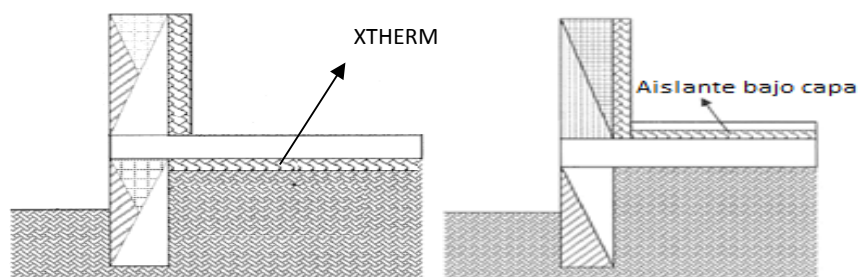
solución “Fibra Xtherm” y solución aislante bajo la capa
